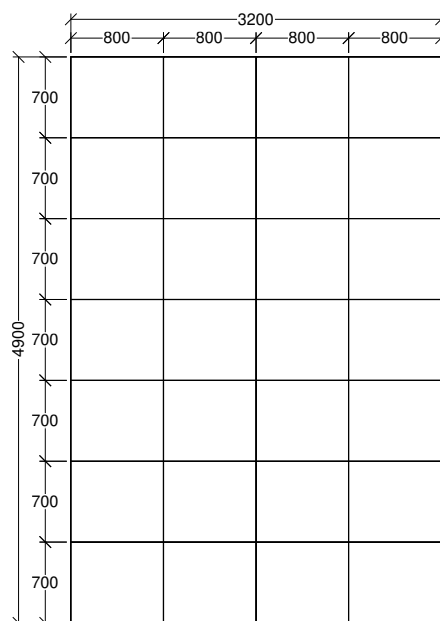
Geometría de edificio, vista en planta, unidades: cm
